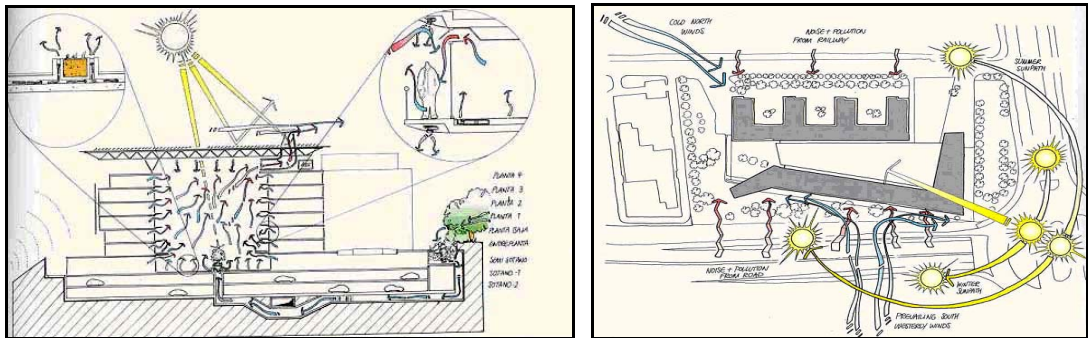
Endesa Merkez Binası plan, kesit ve görünüşü [40-41]
